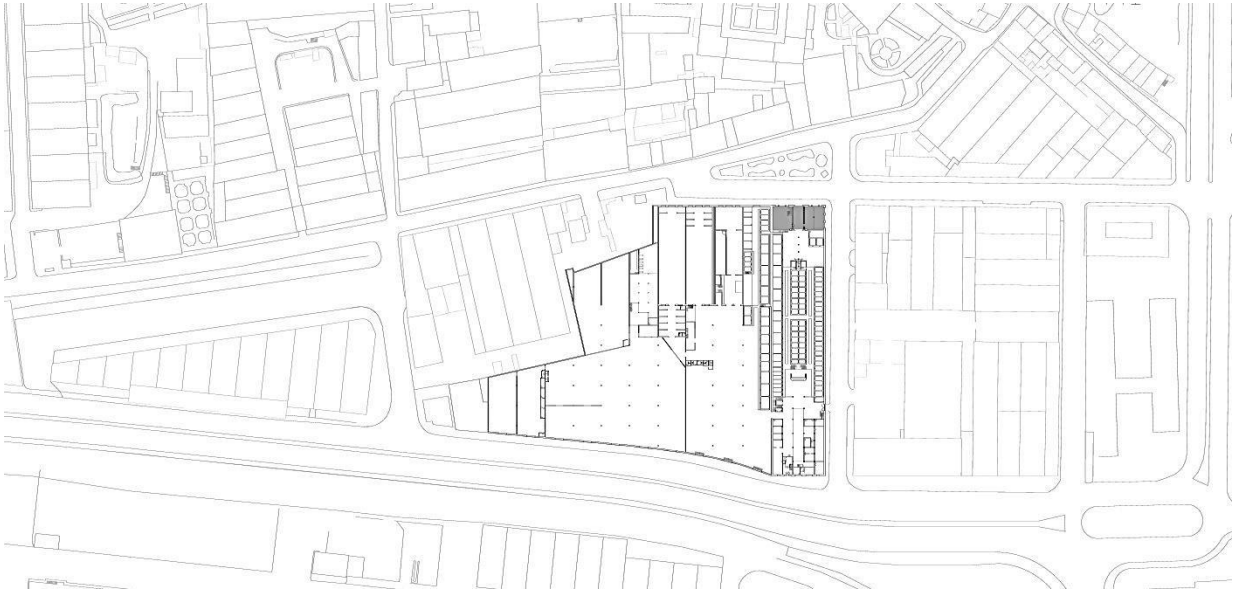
Planta de levantamento fotográfico piso térreo – Armazém 1.
